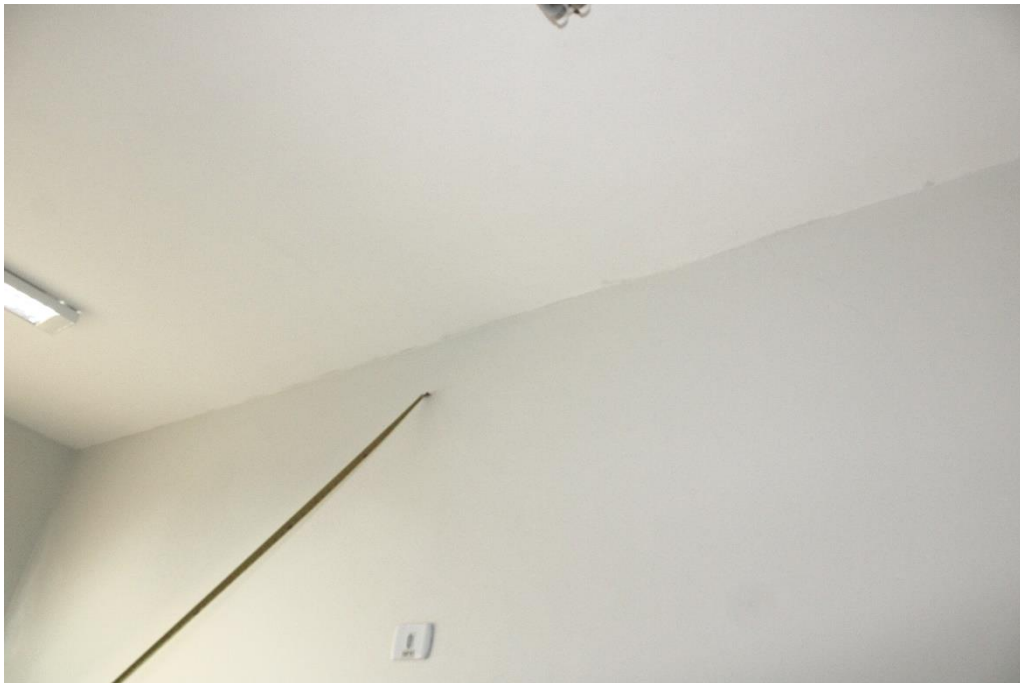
Vista parcial da sala 49, destacando fissura em alvenaria.
